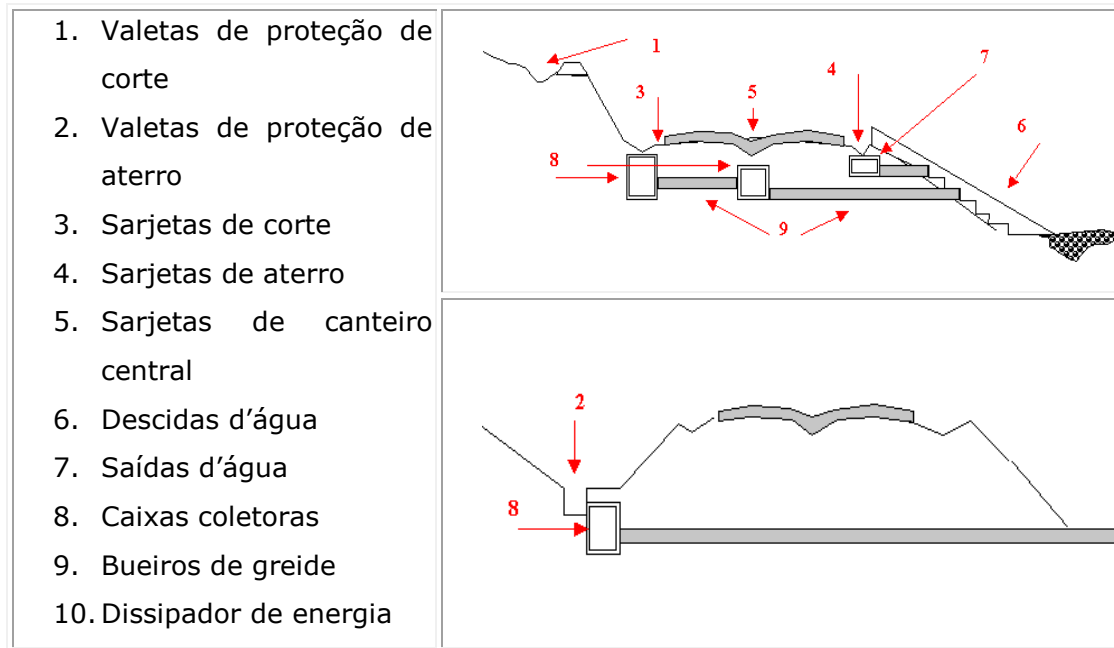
Estruturas dos sistemas de drenagem
